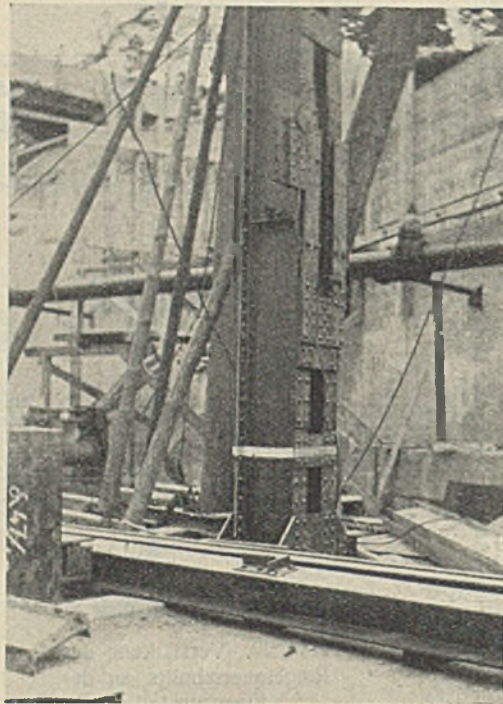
Die obere Auflagerkonstruktion an den Stützen ist vor Einführung der Riegel behelfsmäßig seitlich angeschraubt.
